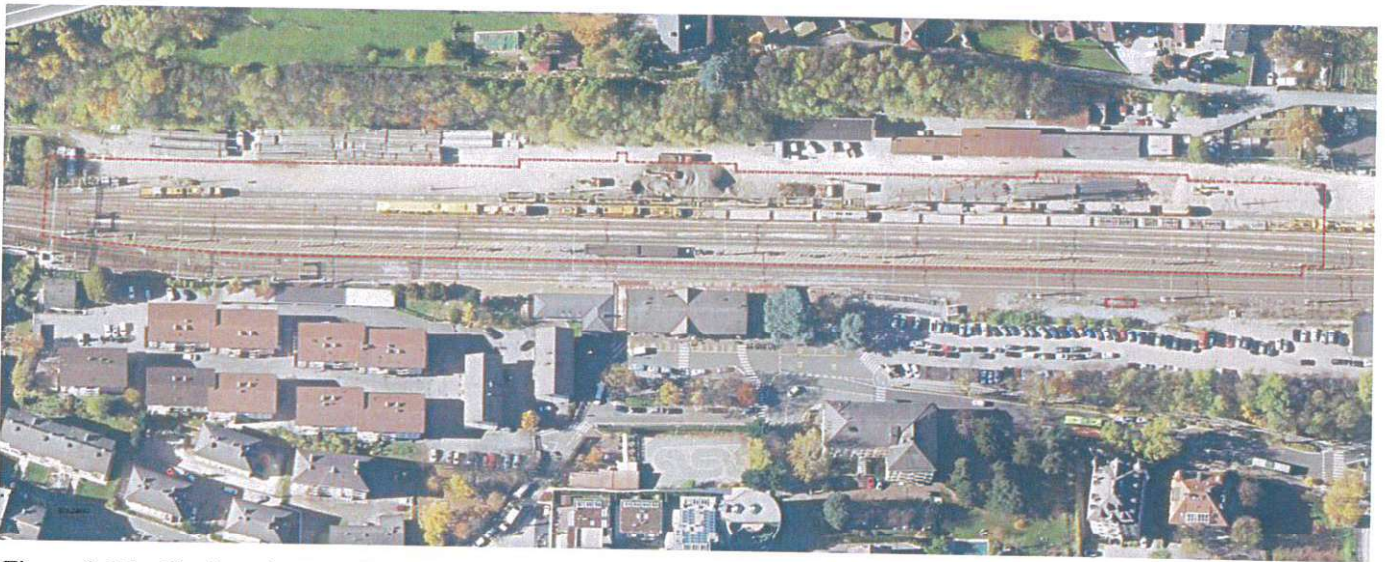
Planimetria generale ante-operam stazione di Bressanone
